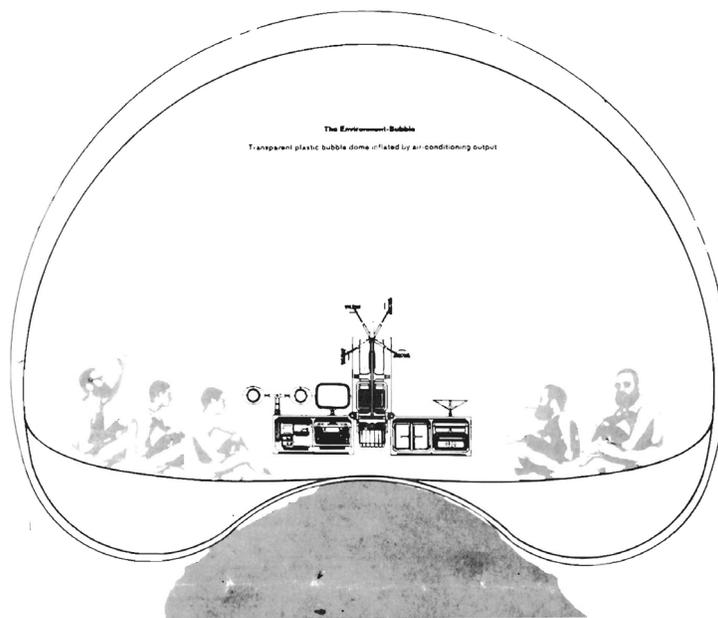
"A home is not a house" de Reyner Banham. Fuente: <https://socks-studio.com/2011/10/31/francois-dalleget-and-reyner-banham-a-home-is-not-a-house-1965/>
